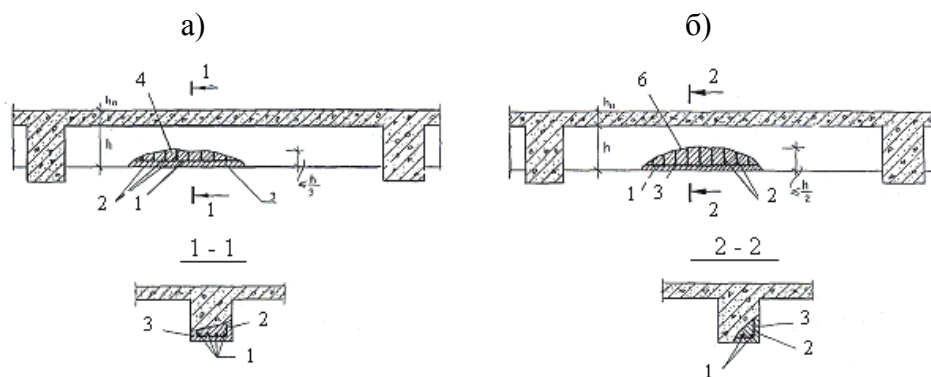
Восстановление железобетонных балок монолитного перекрытия при отколе в растянутой зоне (а) и при отколе угла (б):
